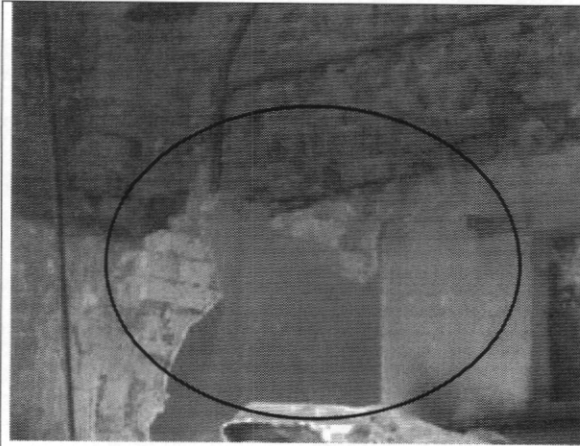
Colapso parcial de muro perpendicular al muro de fachada
